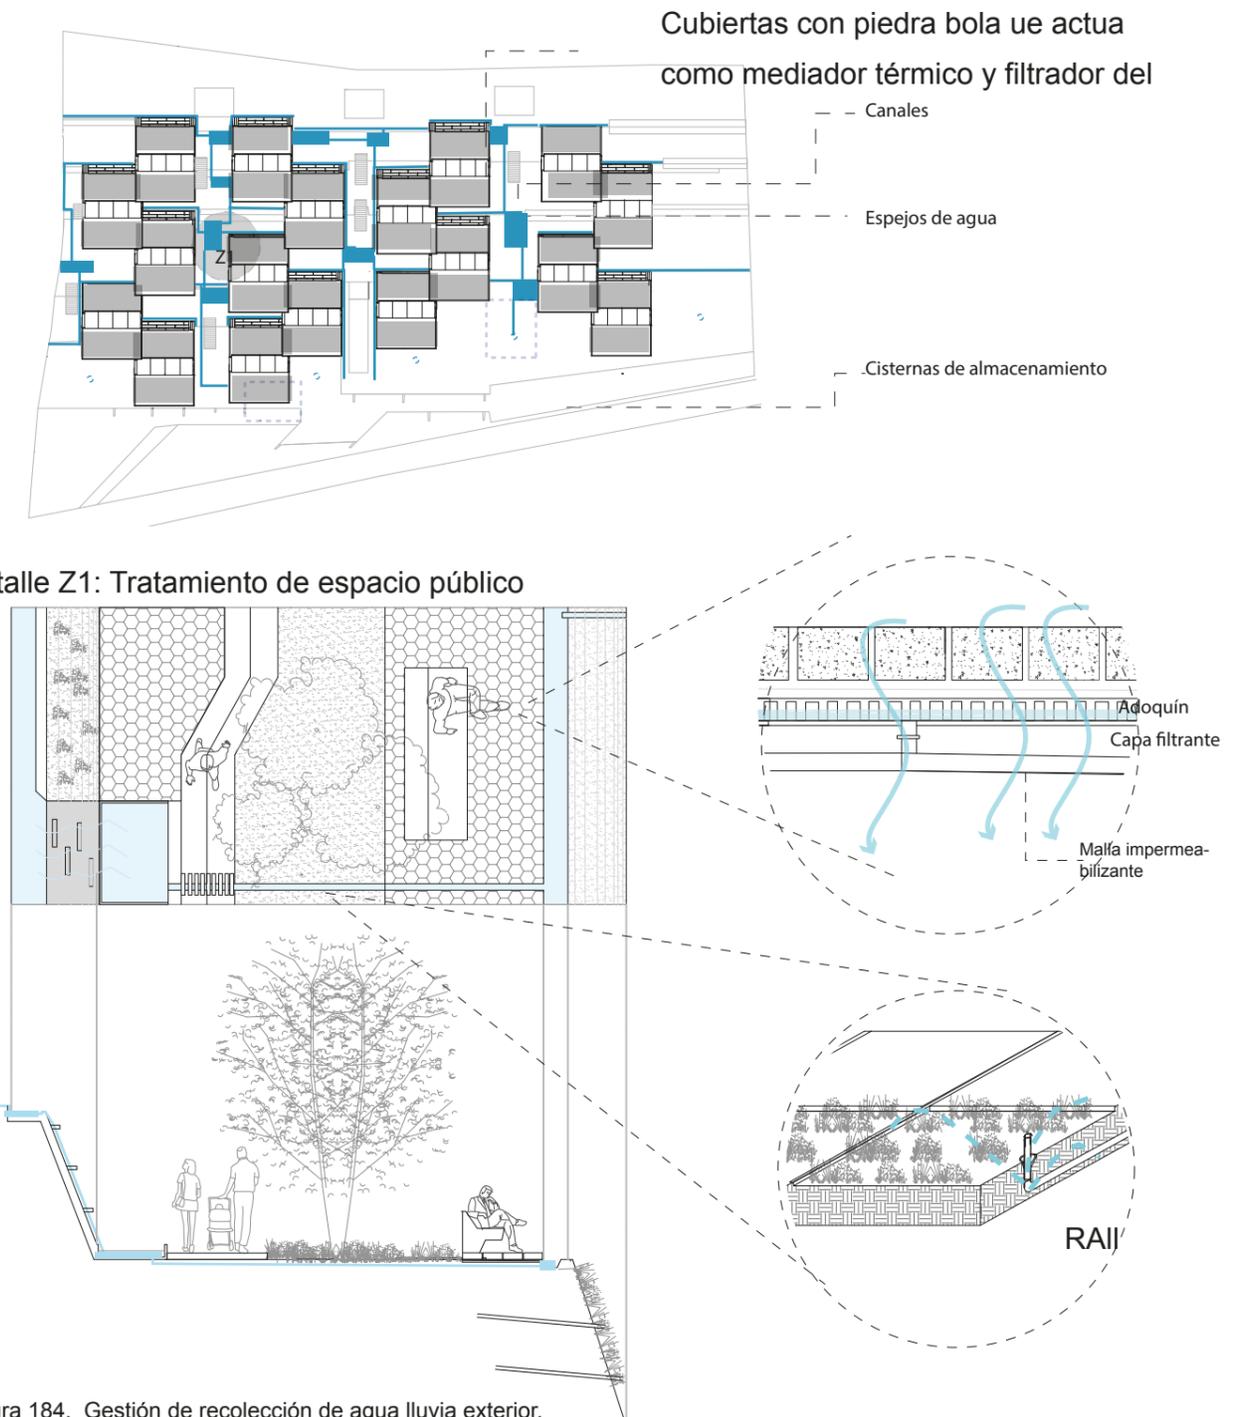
Gestión de recolección de agua lluvia exterior. a) planta b) Detalle de tratamiento de piso.
